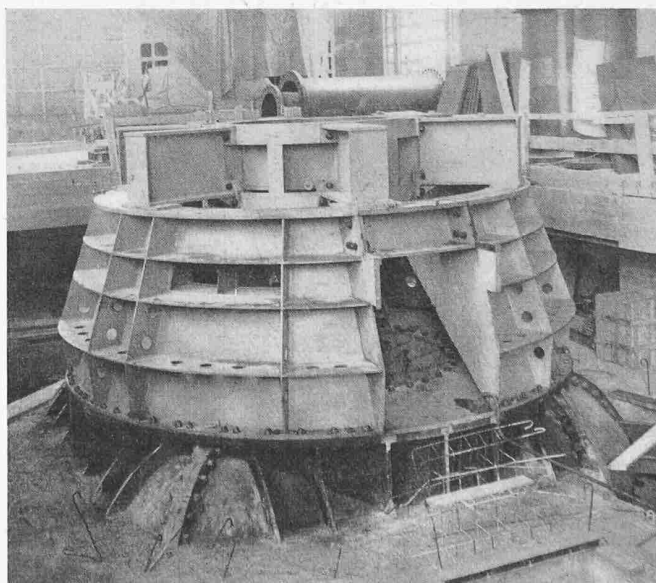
Stützring, darunter das teilweise einbetonierte Gehäuse
